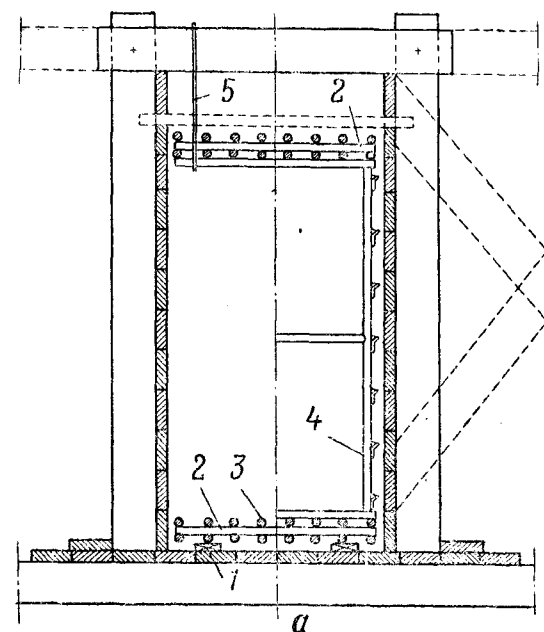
Разъемный металлический барабан для изготовления каркасов звеньев круглых железобетонных труб:
